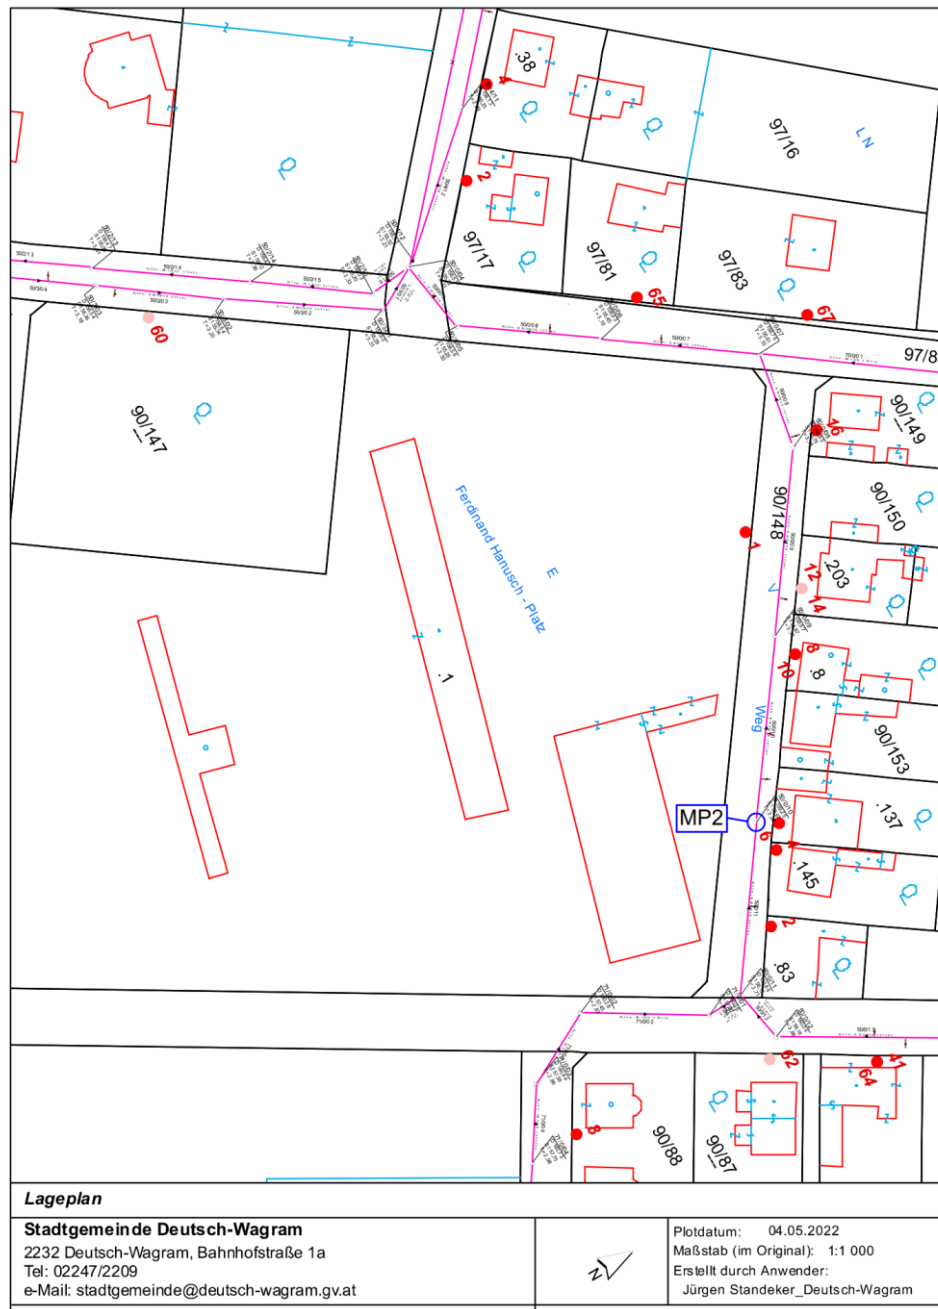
Detailausschnitt Lage/Haltung Messpunkt 2
